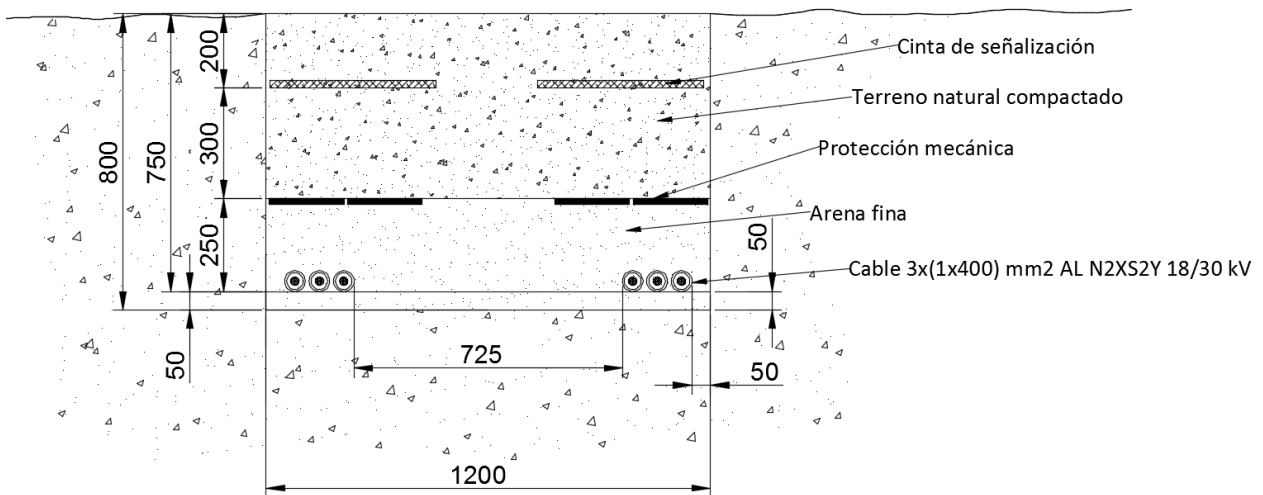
Doc. I. Memoria - Detalle Zanja MT. Cables directamente enterrados.
